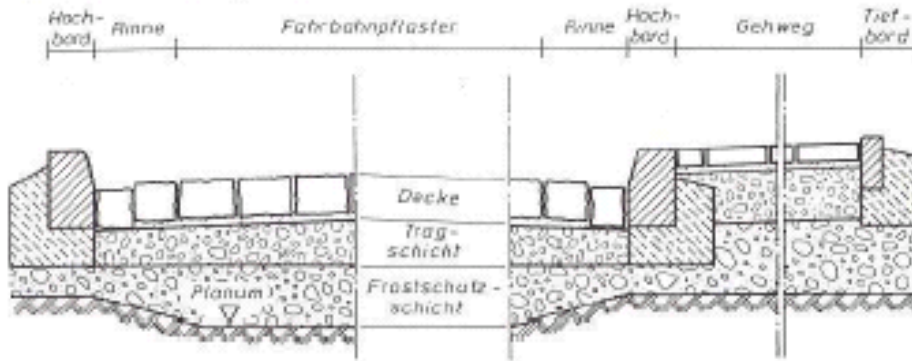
Aufbau eines Straßenkörpers mit Gehweg
